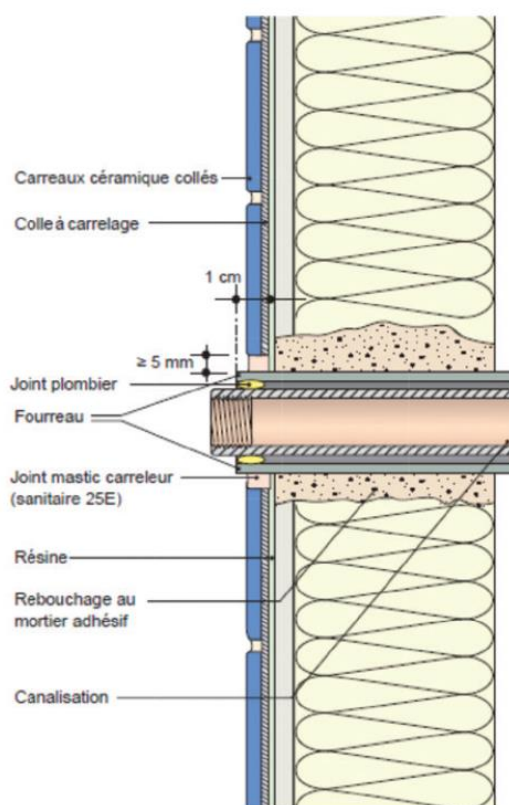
Traitement d'une canalisation traversante avec fourreau en paroi verticale ; exemple d'une cloison en plaque de parement en plâtre.
